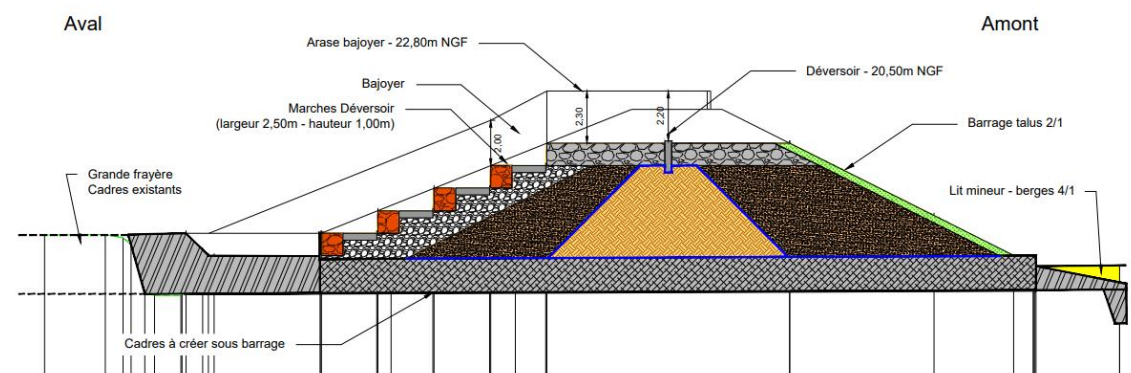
Coupe au droit de l'évacuateur de crue (Plans AVP)
